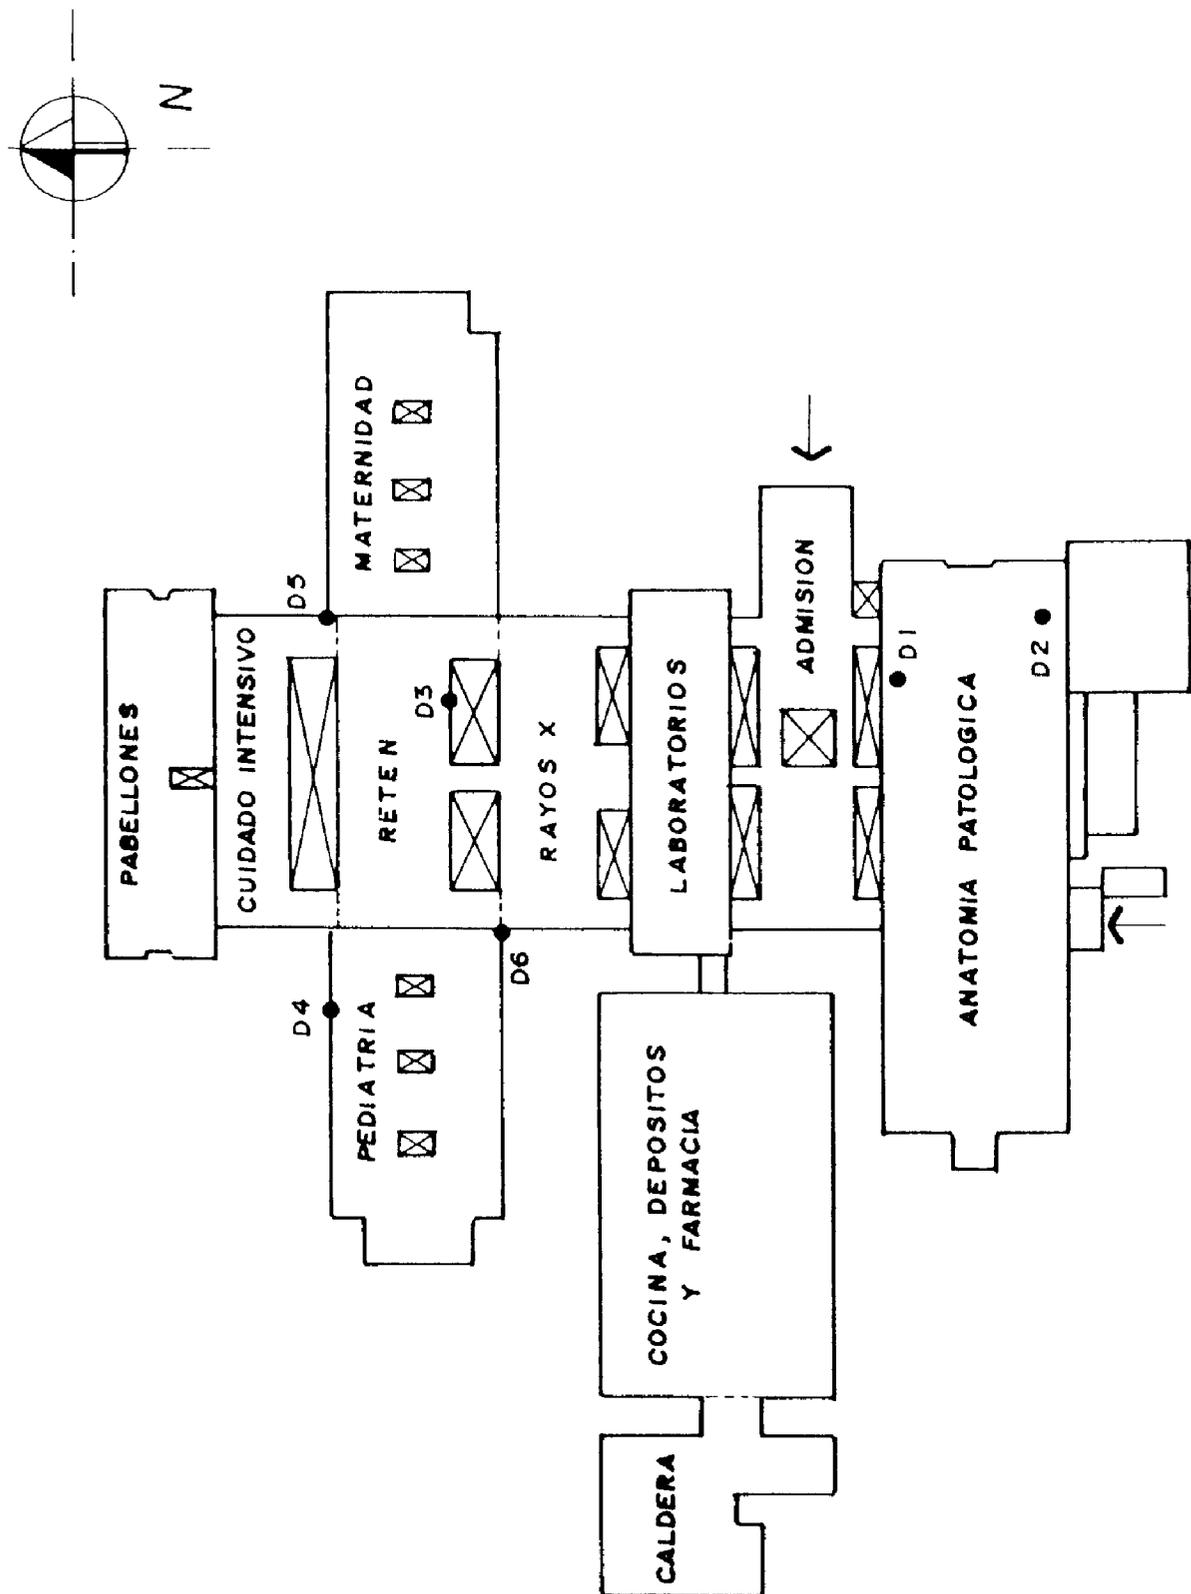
UBICACION EN PLANTA DE LAS COLUMNAS DONDE SE EXTRAJERON CORE-DRILL
